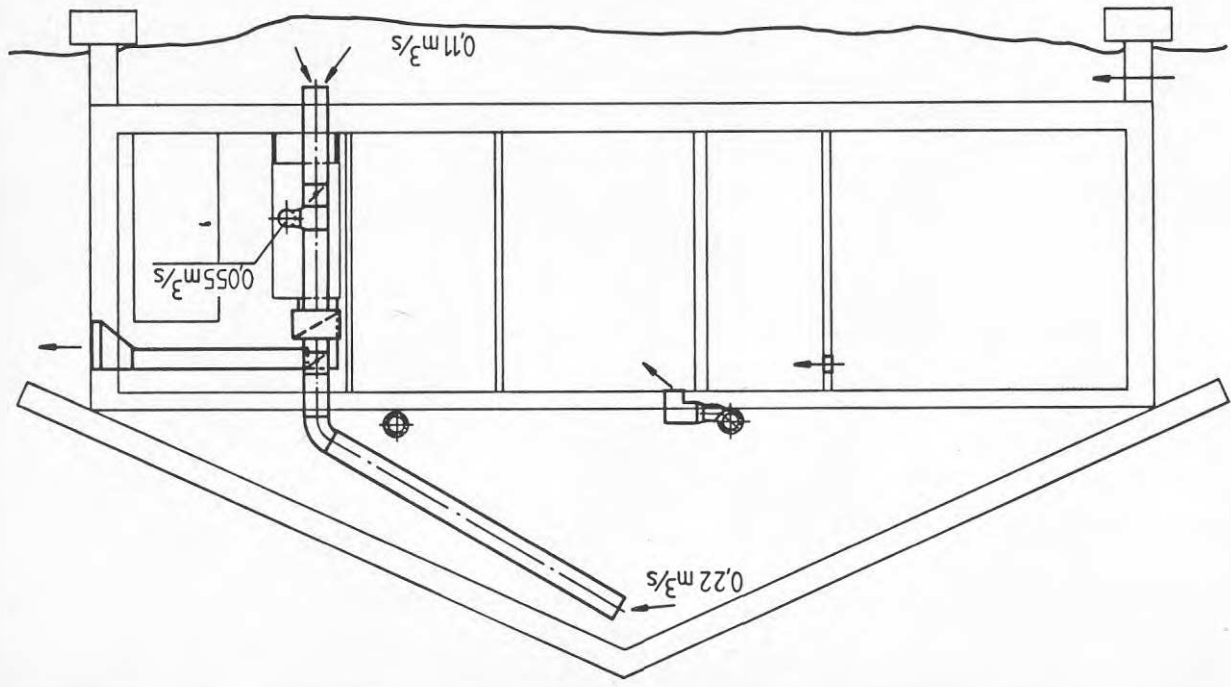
VENTILATIONSSCHEMA, ANLÄGGNING KRISTIANSTAD
